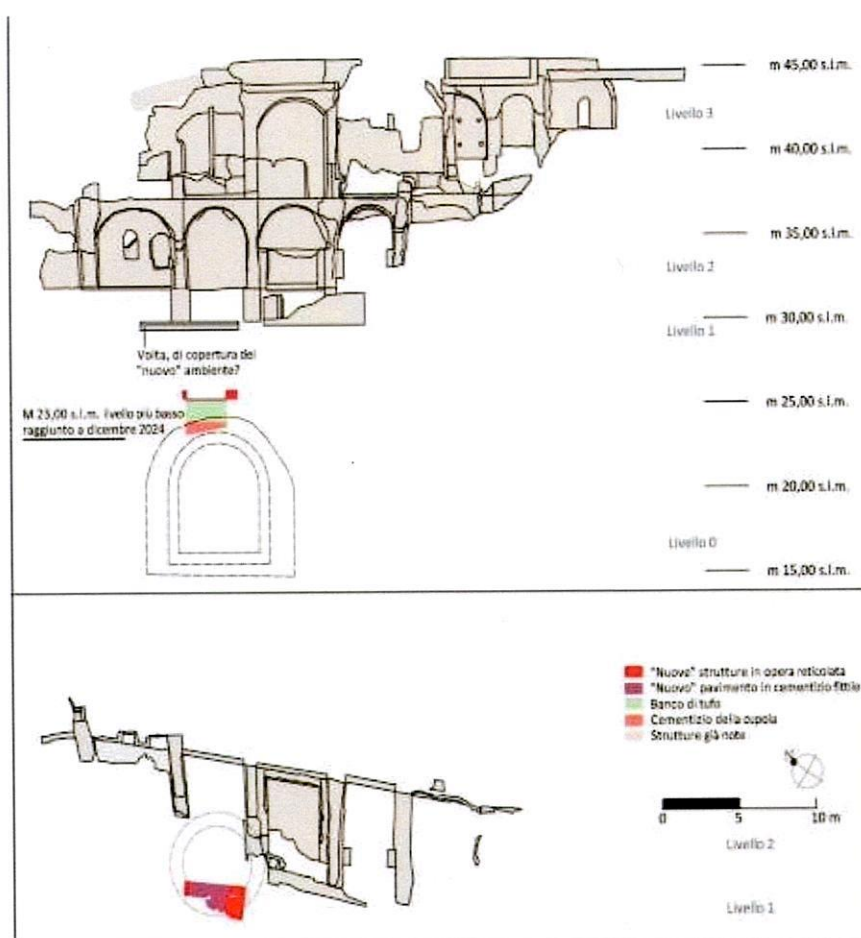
Rapporto tra le "nuove" strutture e quelle già note in pianta e in sezione.
